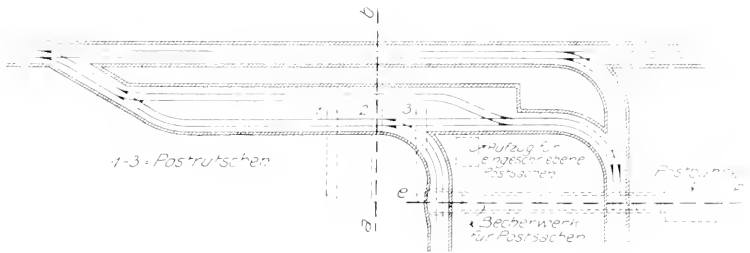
Grundriss eines Teils der Gleisanlagen in Höhe der Tunnelbahn.
